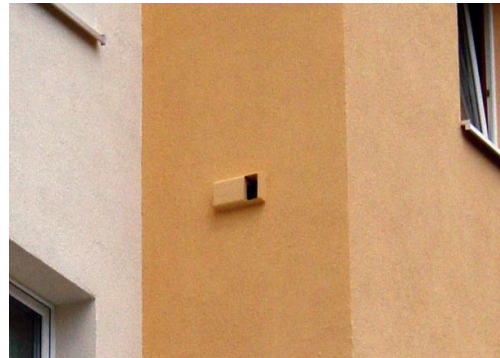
Fassaden-Einbaukasten 1HE, Einbaubeispiel Fassade (Quelle: www.schwegler-natur.de)
